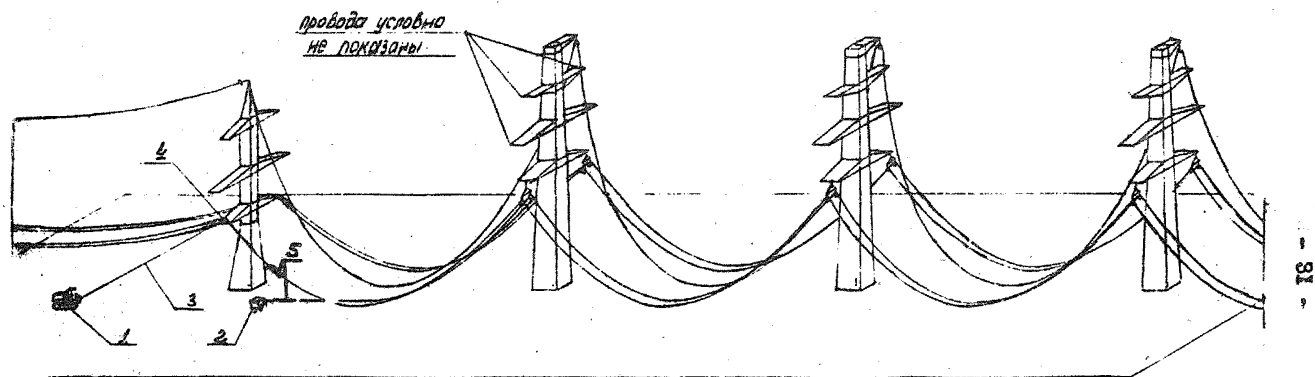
Подъем свободной натяжной гирлянды на анкерно-угловую
